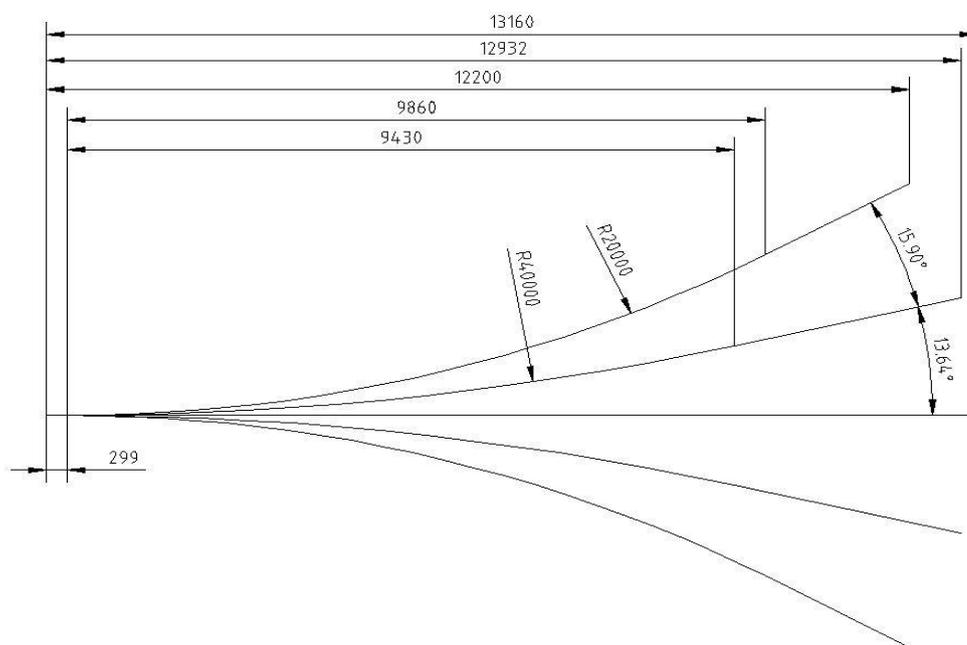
平移型五开道岔线型(尺寸单位: mm)
